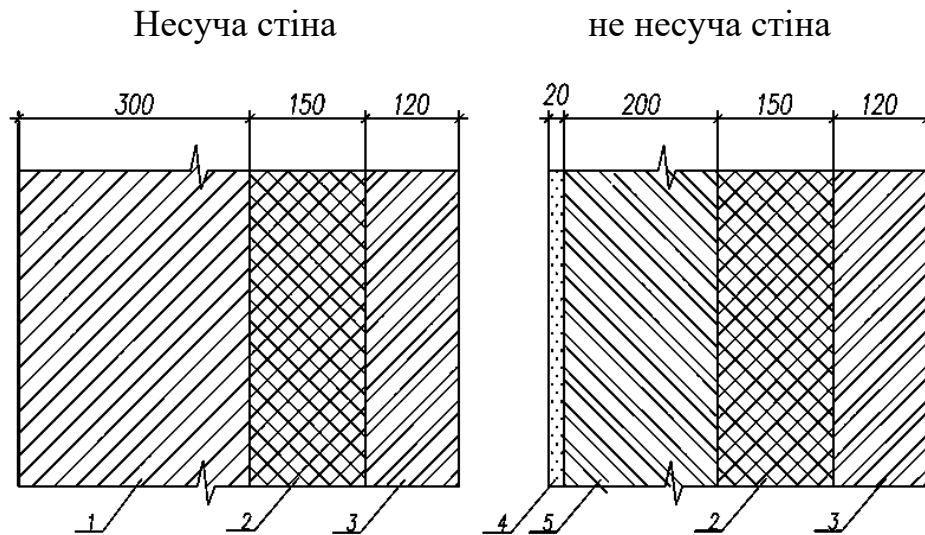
Конструктивні схеми стін: 1 – стіна з монолітного залізобетону; 2 – теплоізоляційний шар з плит URSA Glasswool П30(Г); 3 – кладка з цегли; 4 – вапняно-піщана штукатурка; 5 – кладка з газосилікатних блоків М 50.
